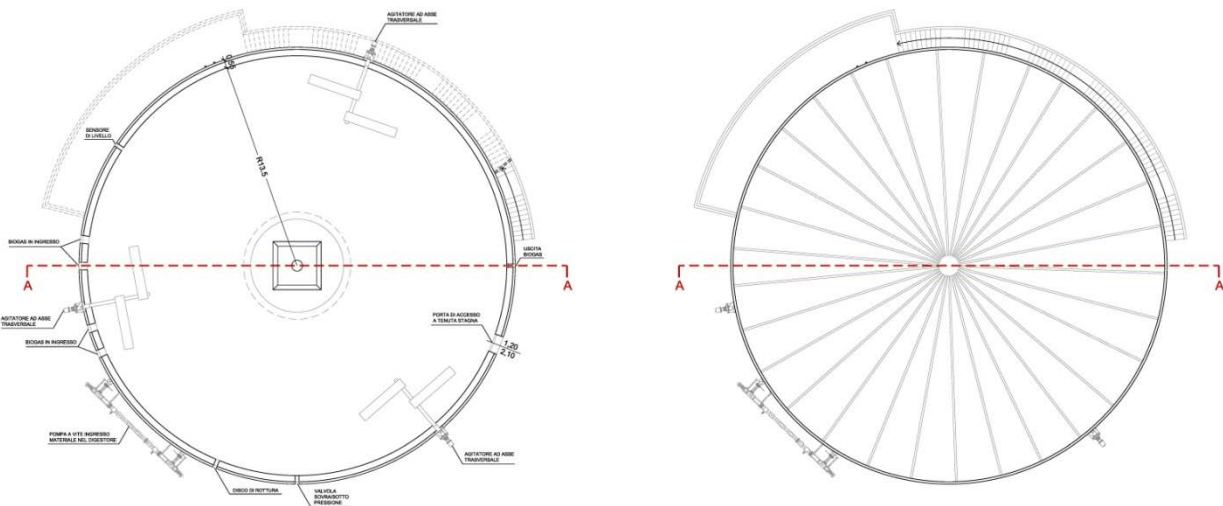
Piante digestore secondario - a sinistra pianta a quota +1,20m a destra pianta delle coperture
